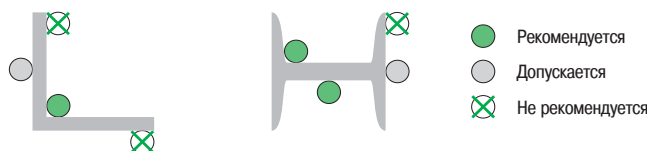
Рекомендации по прокладке кабелей в стальных балках
